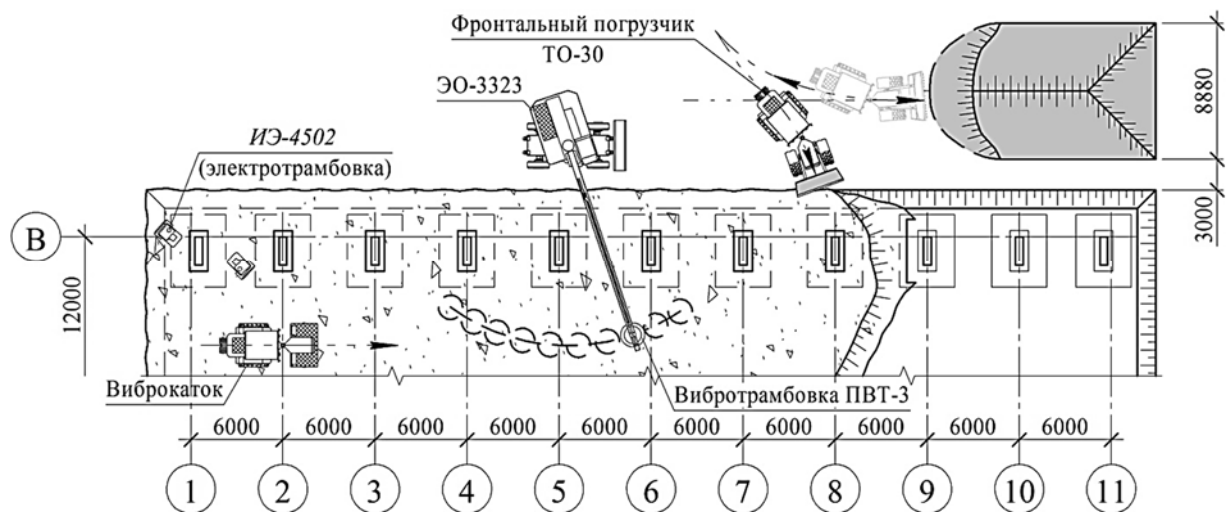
Схема обратной засыпки с помощью фронтального погрузчика и уплотнения грунта в котловане с помощью падающей трамбовки
